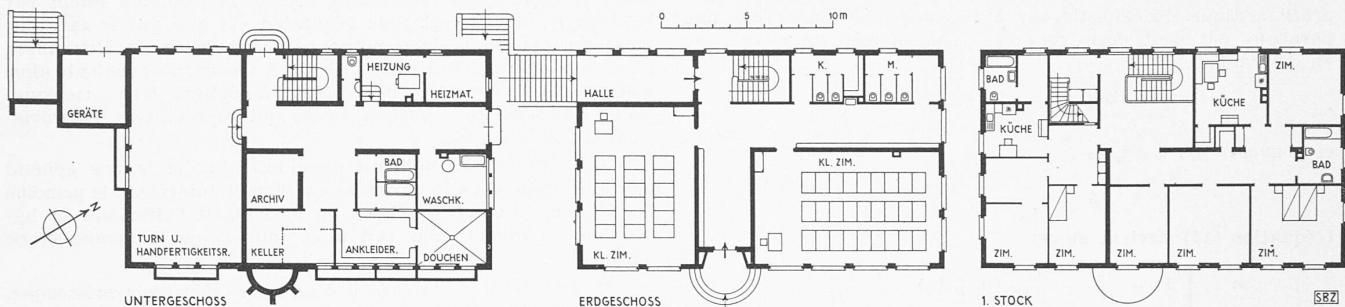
bis 3. Grundrisse 1:400 und Abb. 4 (rechts): Schulhaus Baggwil
